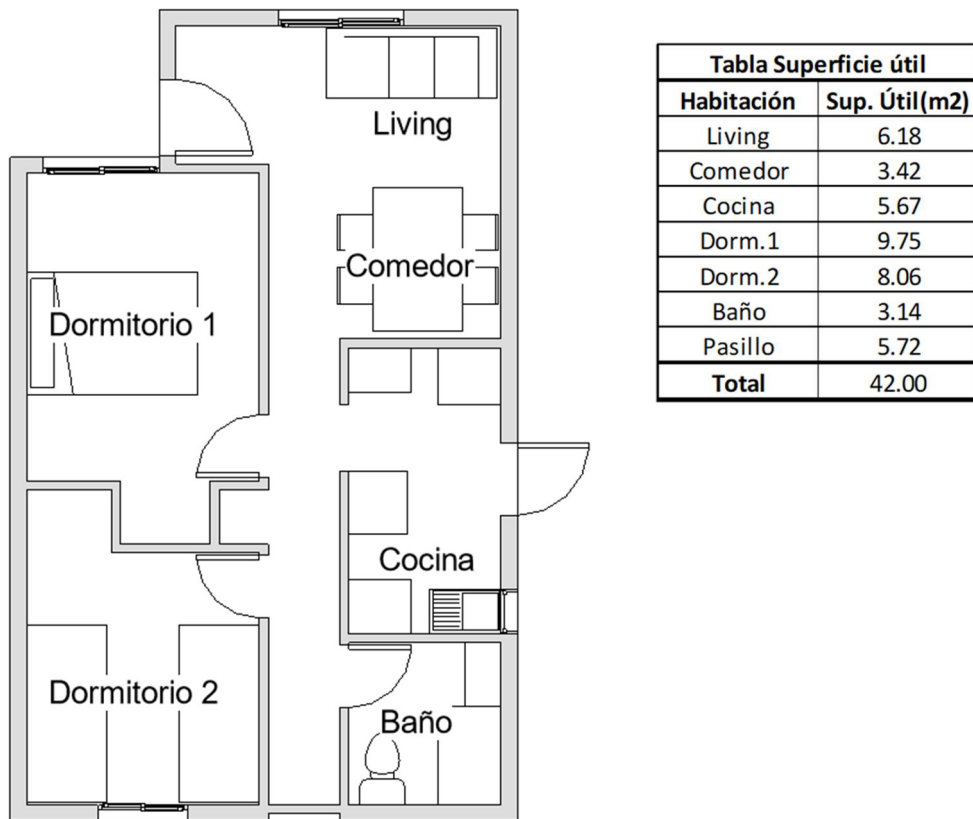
Planta de arquitectura y tabla superficie útil - Vivienda objeto
